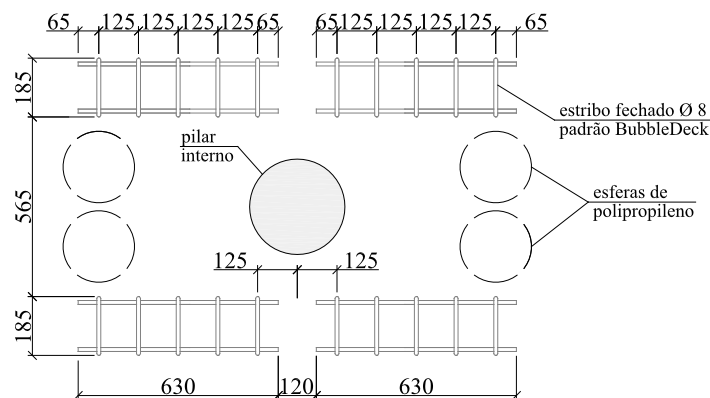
Detalhe em planta das armaduras de cisalhamento das lajes BD1 e BD2
